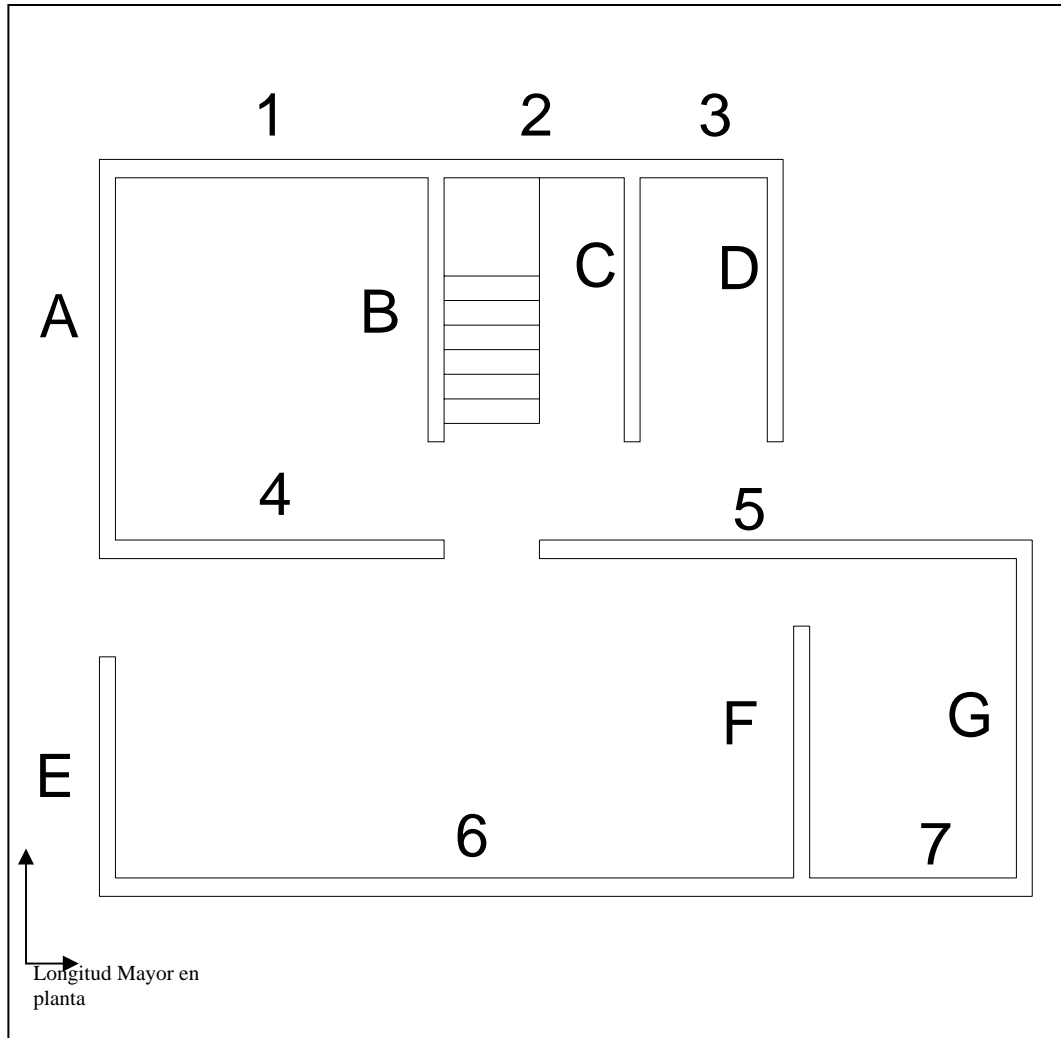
PLANO UNO EN PLANTA SEGUNDO PISO CASA DE DOS PISO
